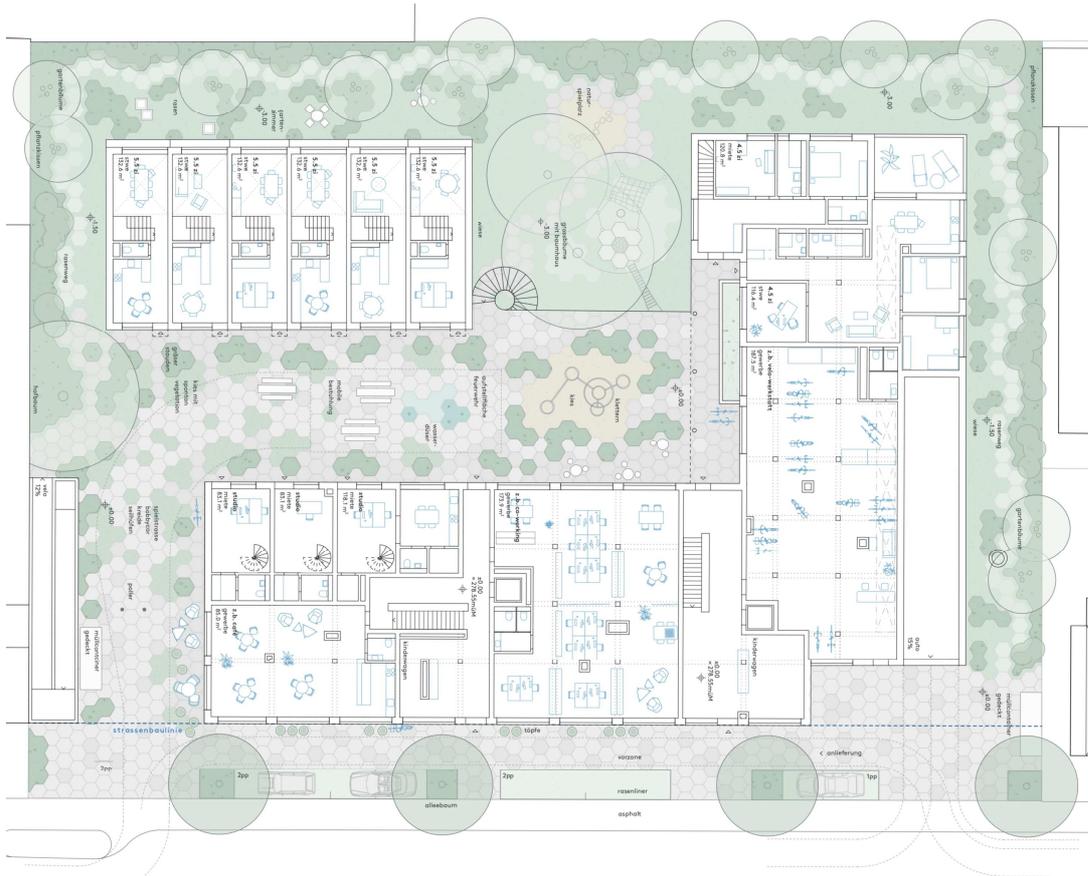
Cour et Couleur: Grundriss EG mit Aussenraumkonzept (Stauffer Roesch AG)
